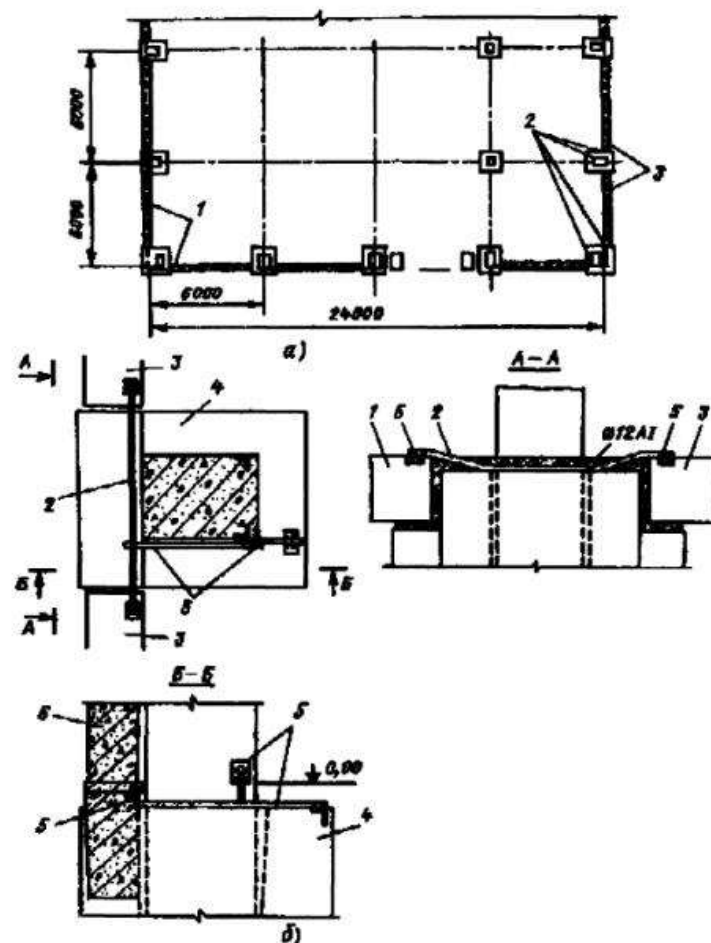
Расположение фундаментных балок при использовании их для объединения (а) и соединение арматуры фундаментных балок между собой и арматурой колонны (б):
